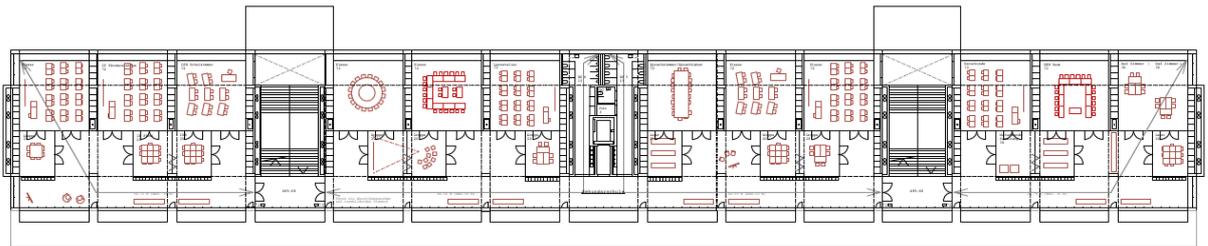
Grundriss 4. Obergeschoss
